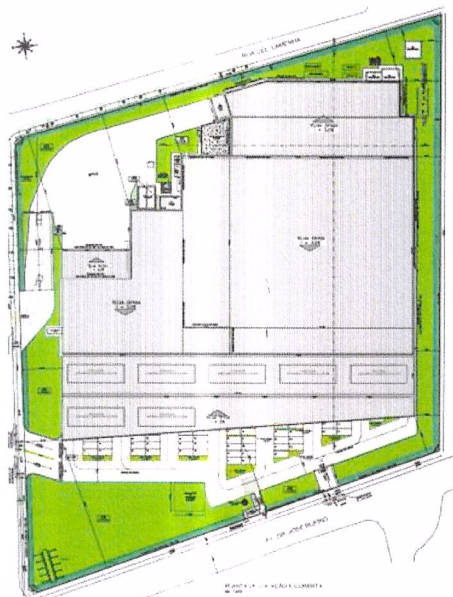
Planta de Locação e Cobertura. Fonte – Projeto, 2022.
